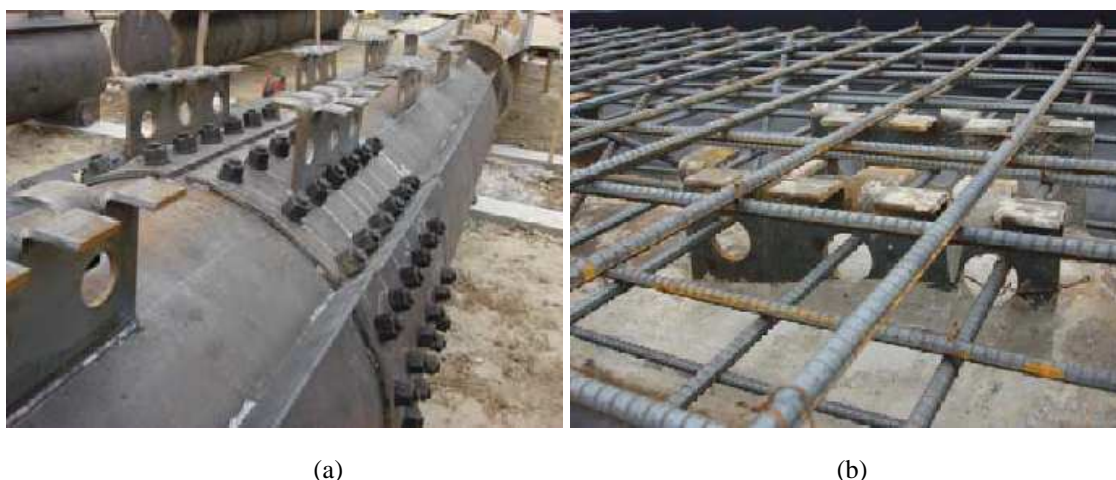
Viga tubular (Chin *et al.*, 2008): (a) Conectores e ligação parafusada; (b) Disposição do conector entre as armaduras da laje.
